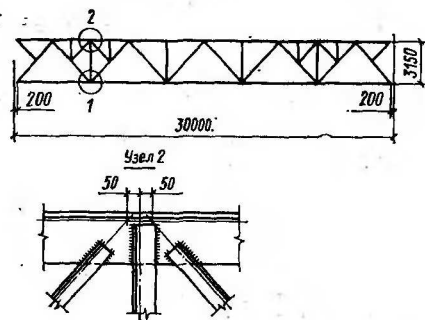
Экспериментальная стропильная ферма пролетом 30 м. Узел 1 см. на рис. 63
